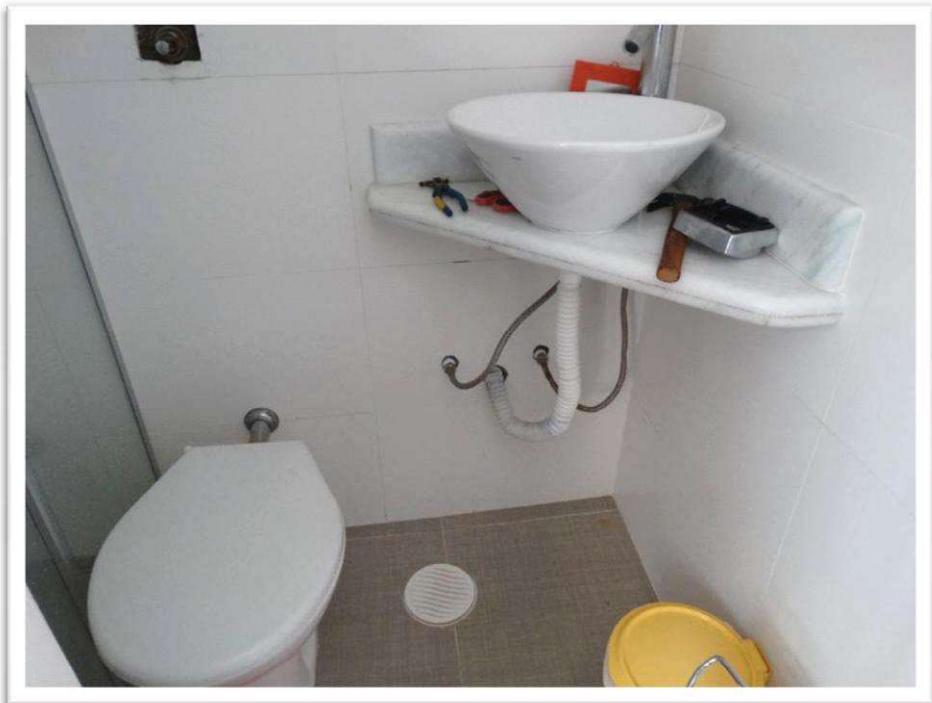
Vista parcial interna do banheiro junto à lavanderia, no imóvel objeto da presente vistoria.
